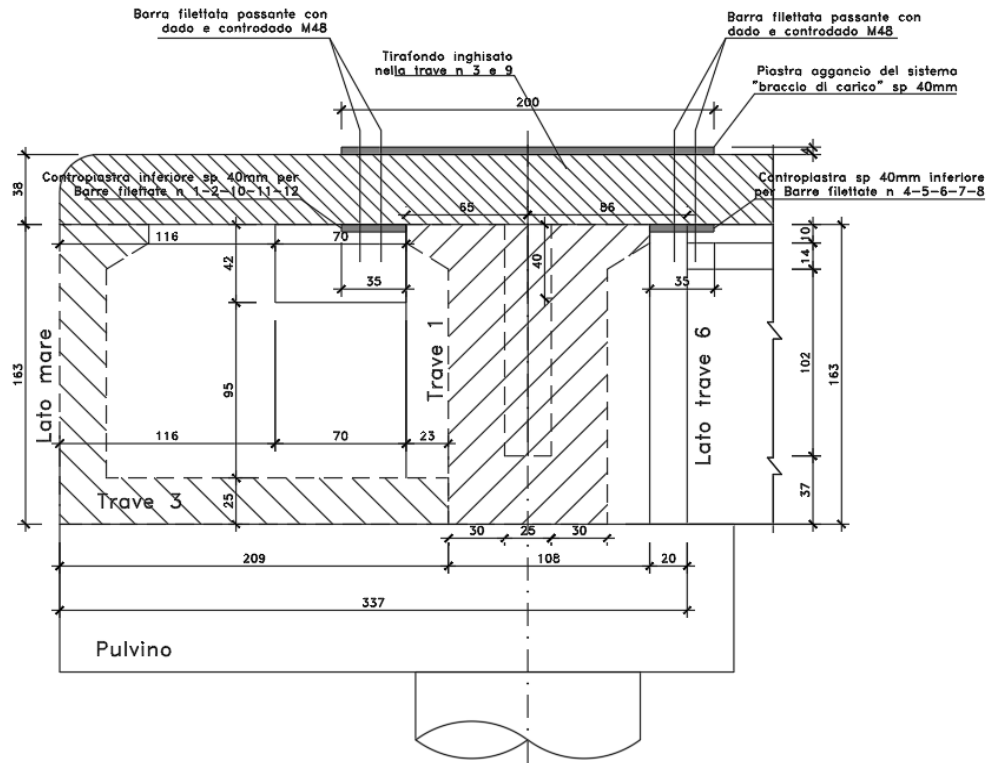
Dettaglio piastra ancoraggio braccio di carico in pianta
